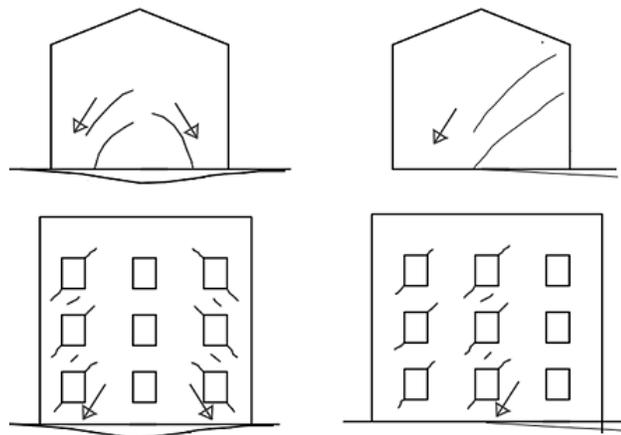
Fisuración por asentamientos (Pérez, 1994).
